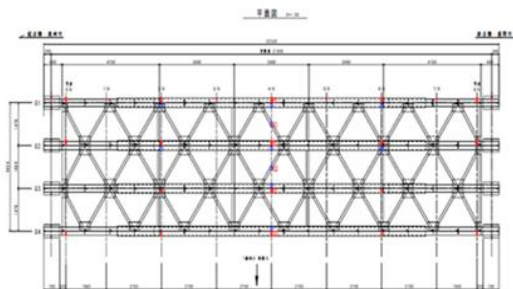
4主鈹桁橋の載荷試験計測設置位置図（平面図）
